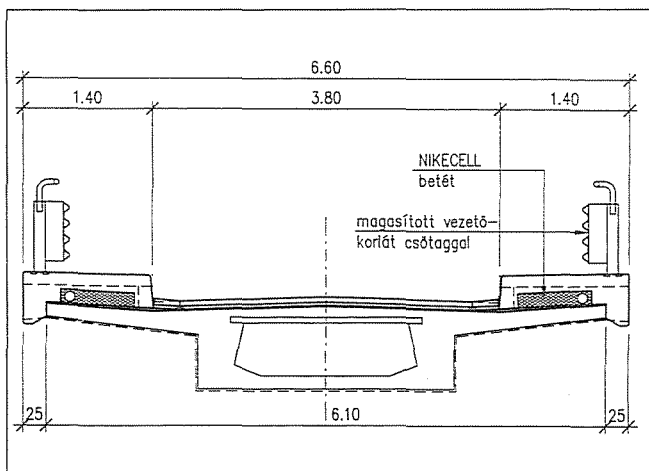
ábra Profilbeton jellemző kialakítása a jobb pályán
